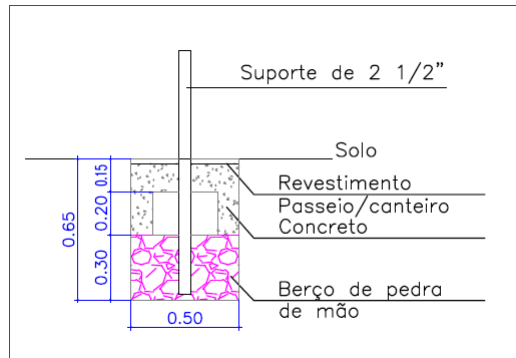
Detalhe de implantação de suporte tipo coluna
